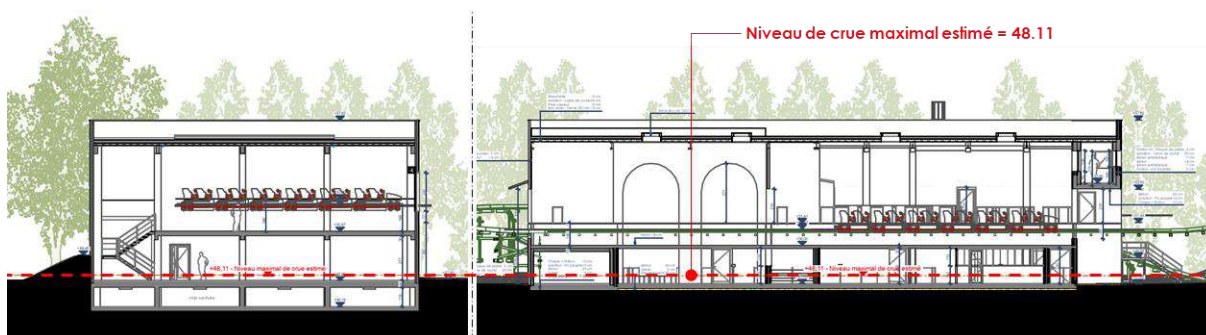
Schématisation du niveau de submersion maximal au droit du projet – Coupe longitudinale
